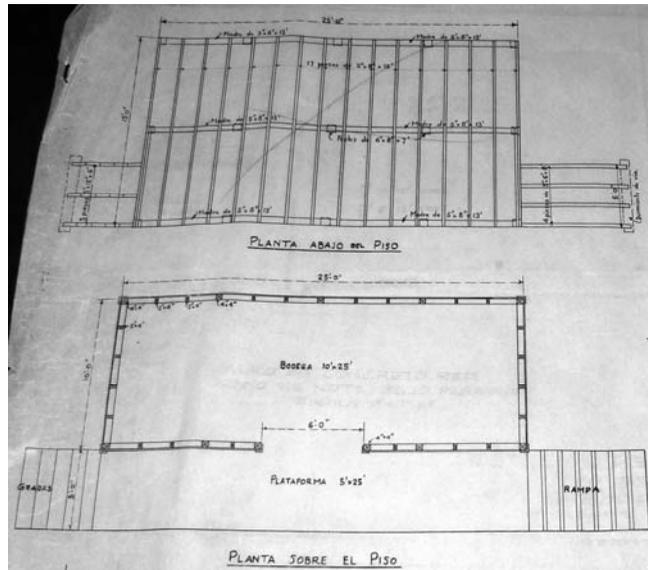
Plano de estación de bandera típica –planta- encontrado en archivo de FEGUA.
